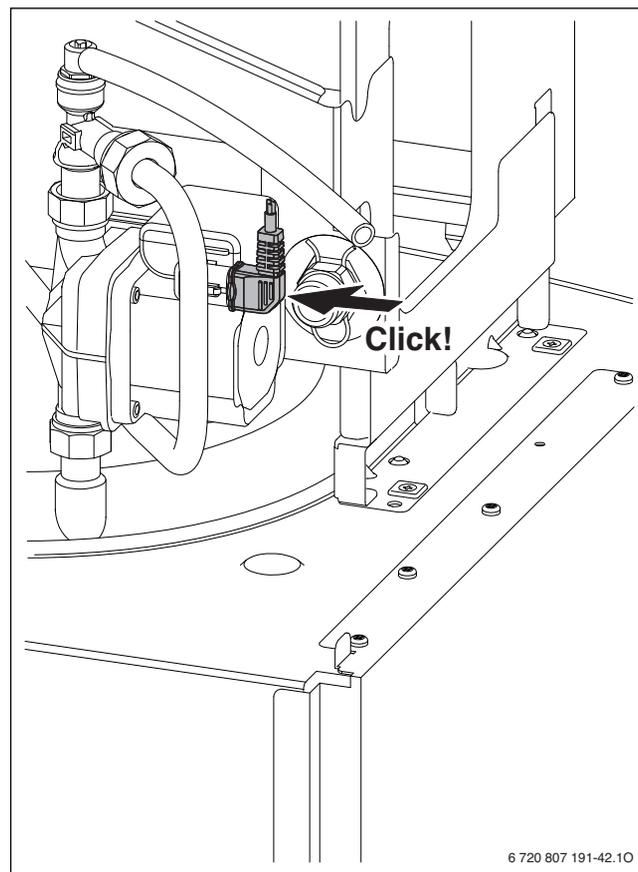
Pumpenstecker vom Gerät auf Speicherladepumpe stecken
